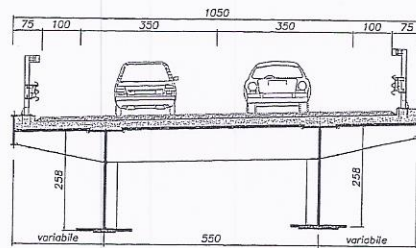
Sezione trasversale del “Ponte sul torrente Pescia”.
